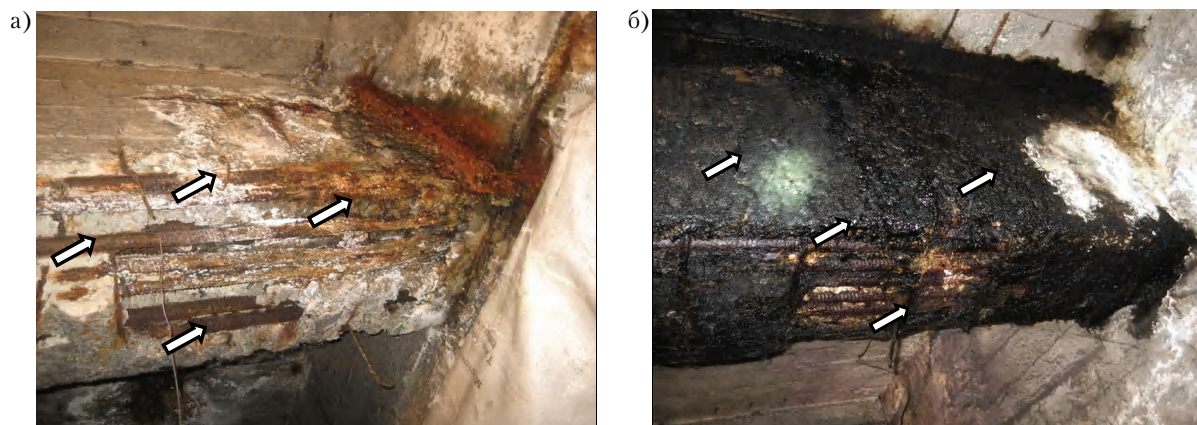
Коррозия железобетона конструкций монолитных балок в результате воздействия воды (а) и машинного масла (б) с разрушением защитного слоя бетона на глубину до 40...50 мм, обнажением и коррозионным износом рабочей арматуры до 10 % поперечного сечения, и обрывами поперечной арматуры.
